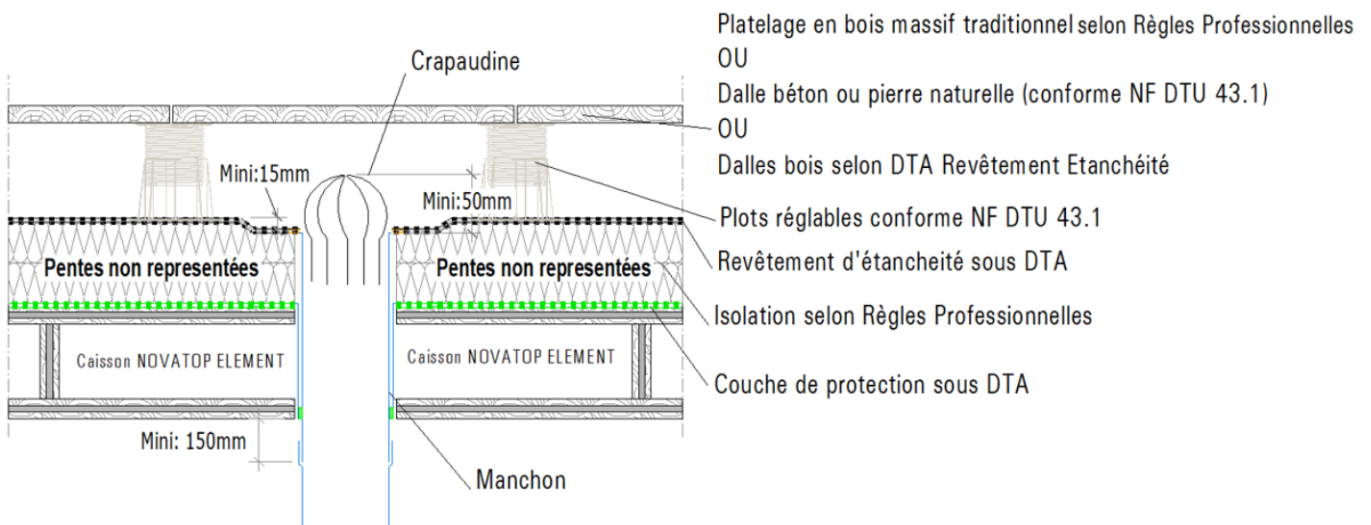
A – Naissance descente EP (terrasse accessible aux piétons et au séjour)
